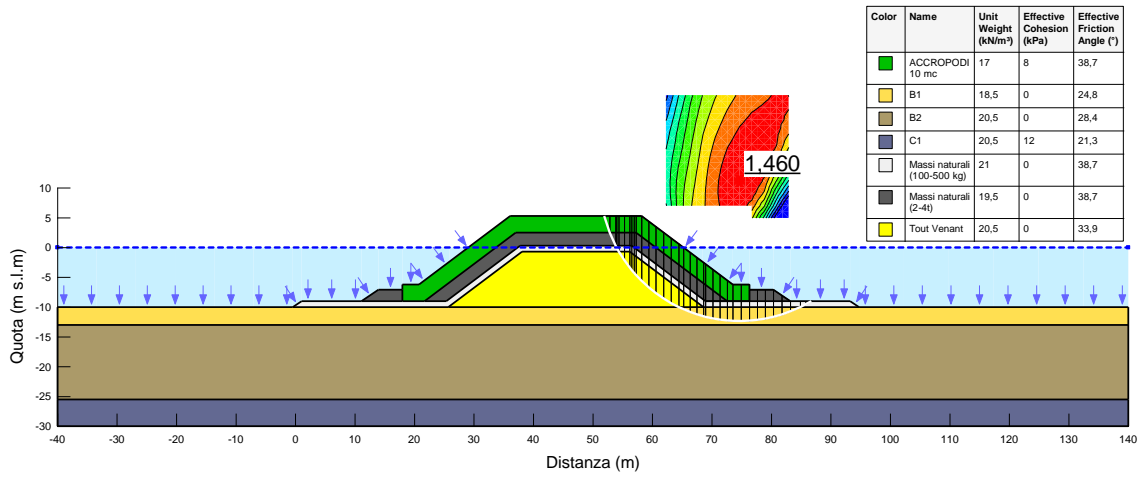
Sezione D – SLU-GEO 2 – Superficie critica destra
